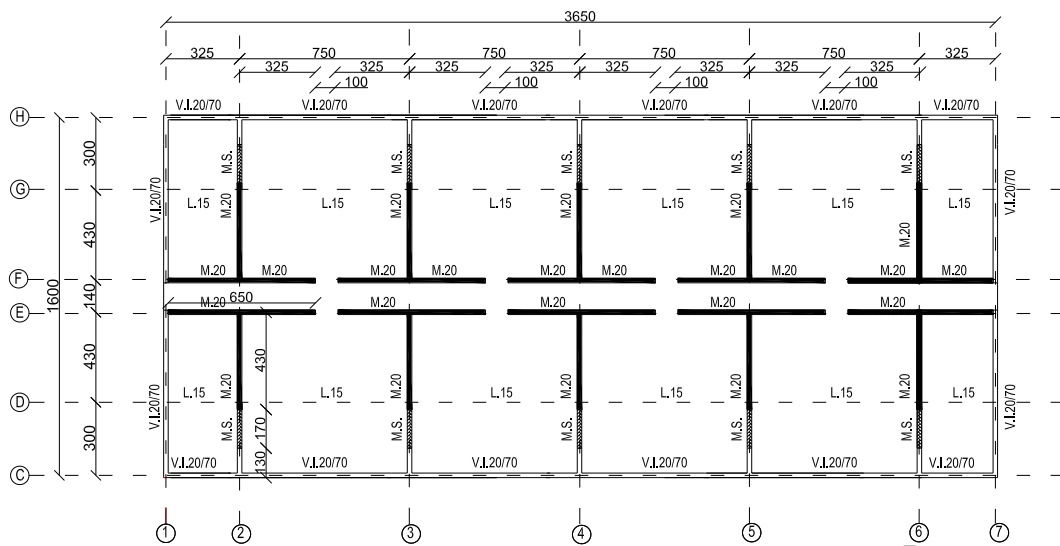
Planta estructura nivel 1º, edificio aislado.
